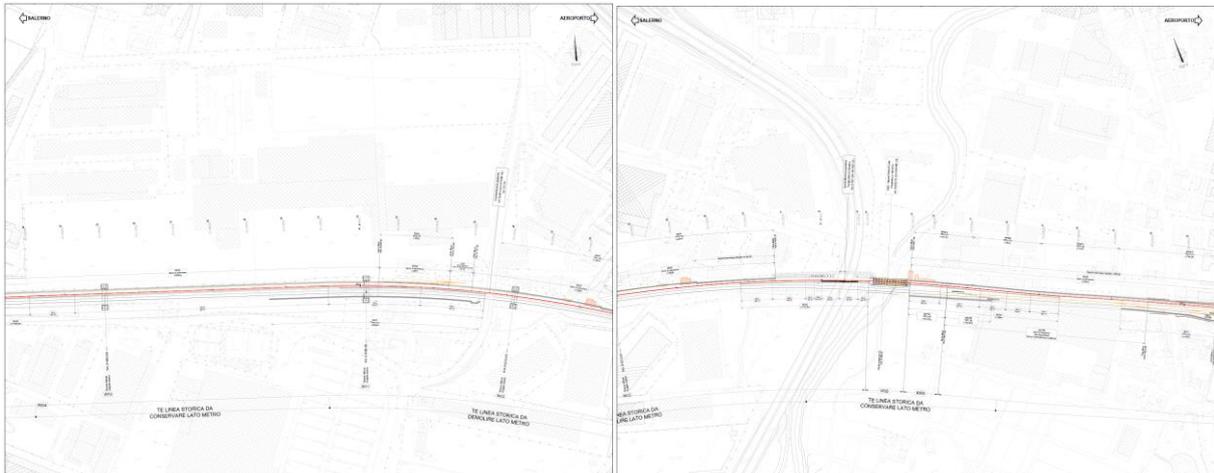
Stralcio della planimetria di progetto dal km 2+600 al km 4+000
